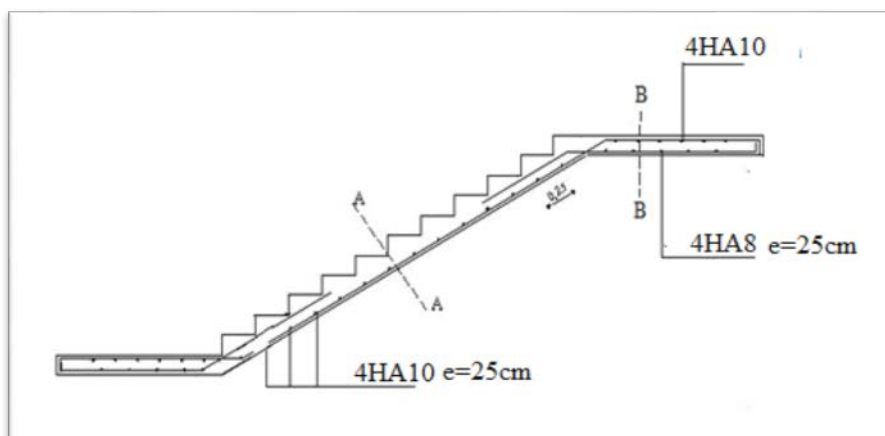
schéma de ferrailage d'escalier type 01 du volée 02
